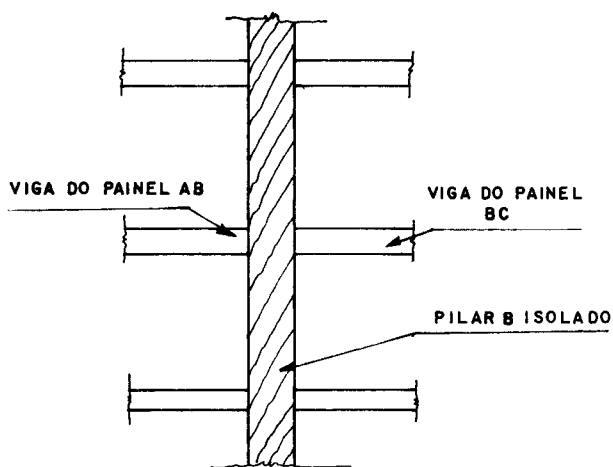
ELEVAÇÃO E PLANTA DO PILAR ISOLADO
